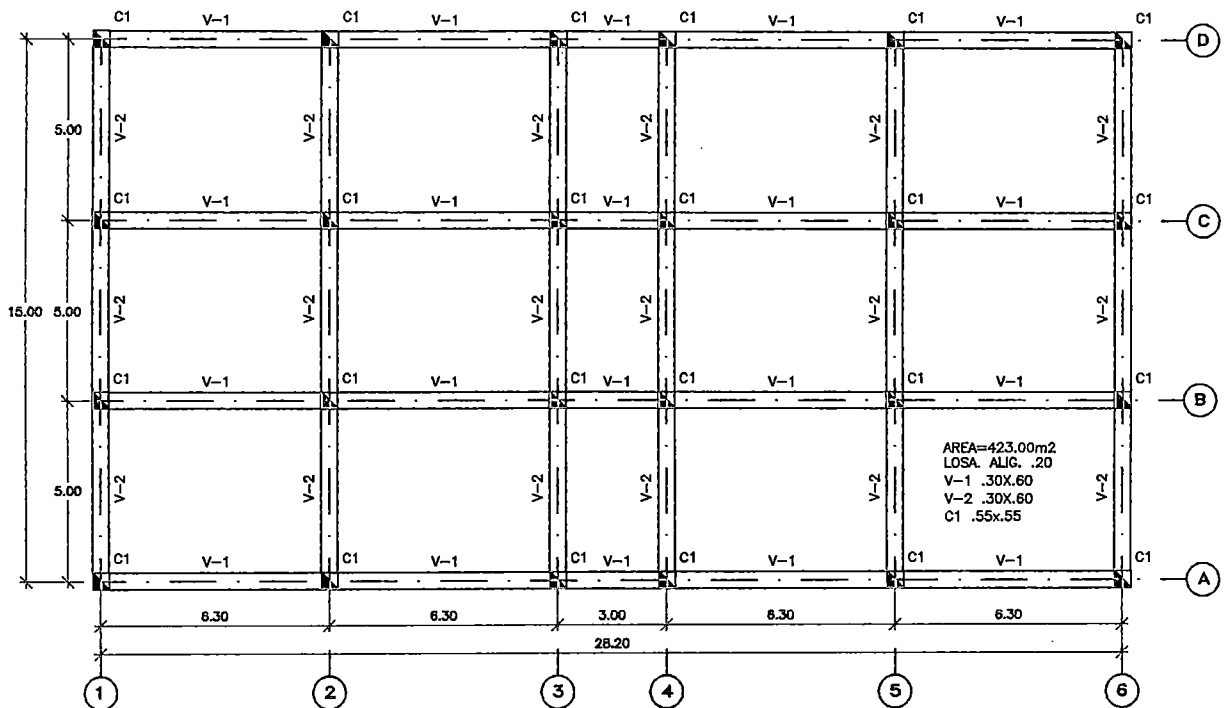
MODELO 02 PLANTA TIPICA
